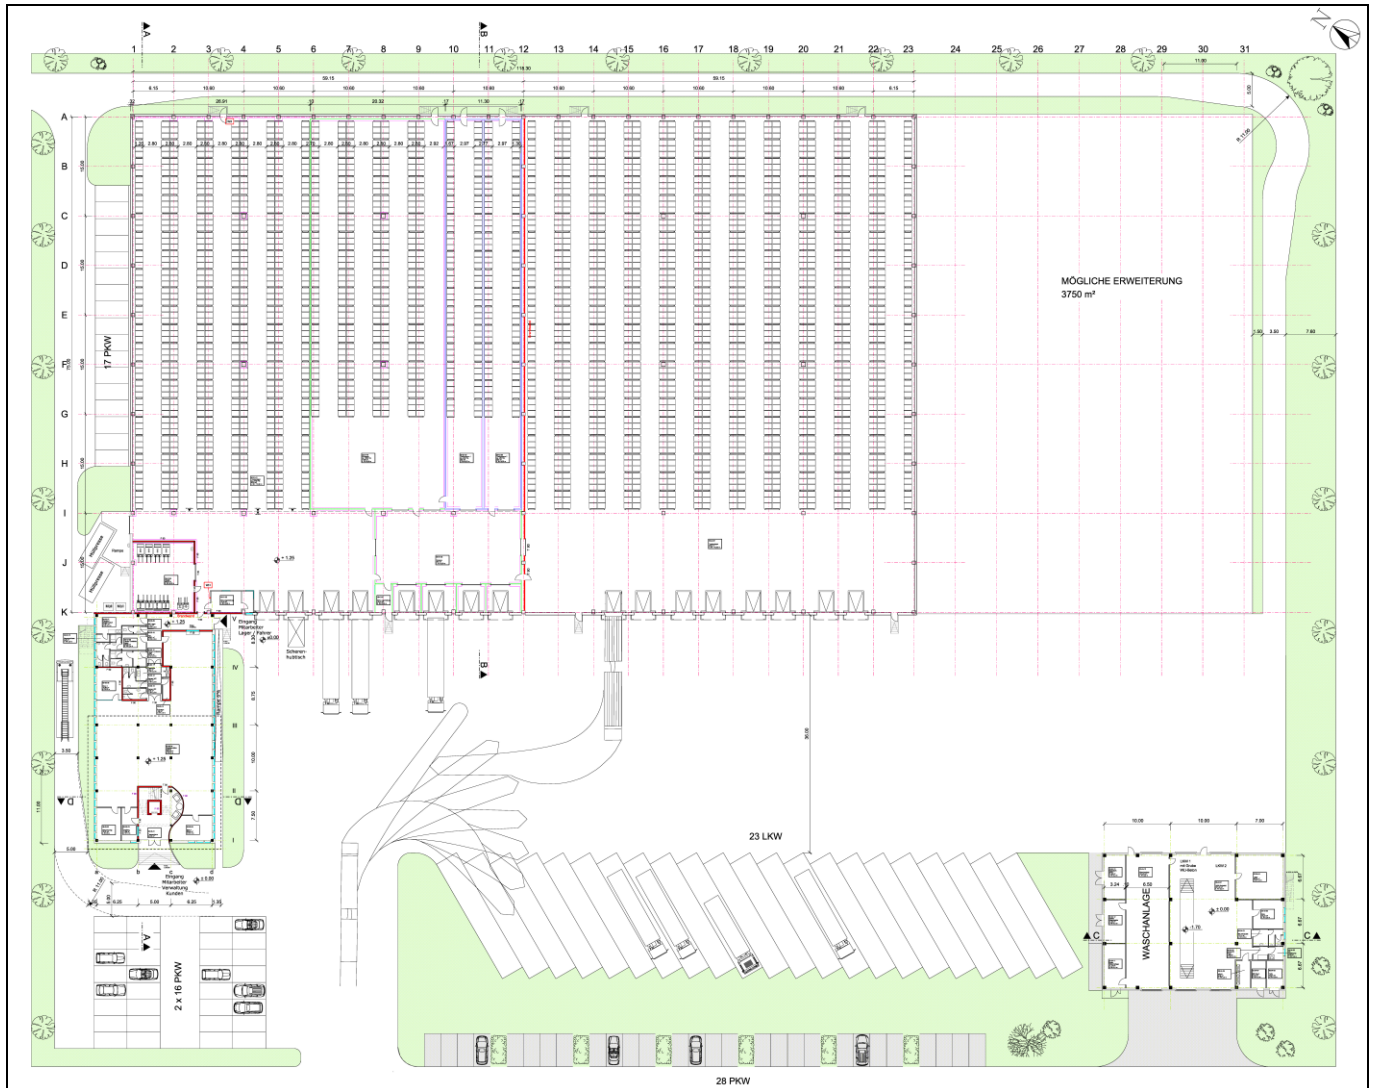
Neubau Firmensitz „Frigo-Trans“, Grundriss EG, Entwurf (Auszug aus /5/)
